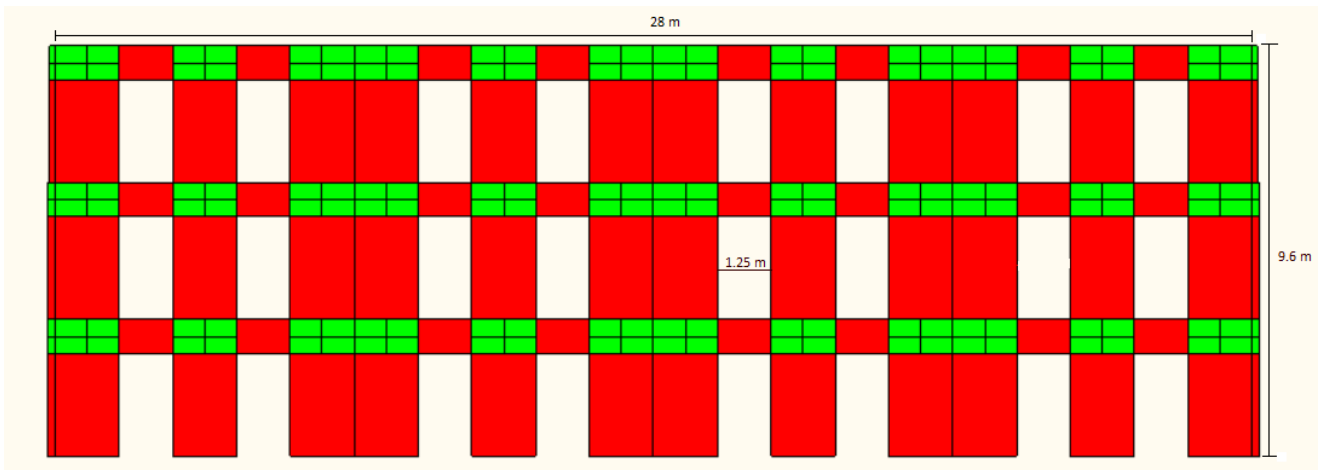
Prospetto ovest dell'edificio esistente
